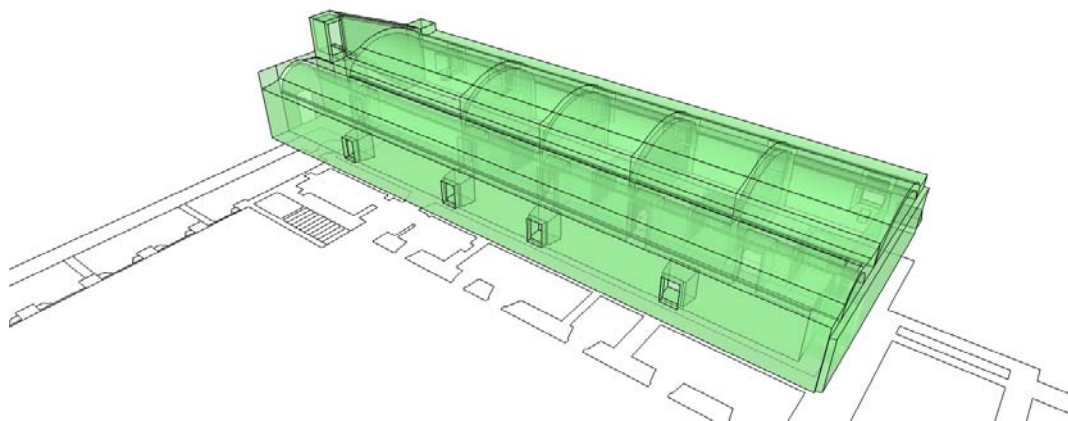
Reconstrucción Virtual Sector 3 b: Ala Norte Planta Alta
